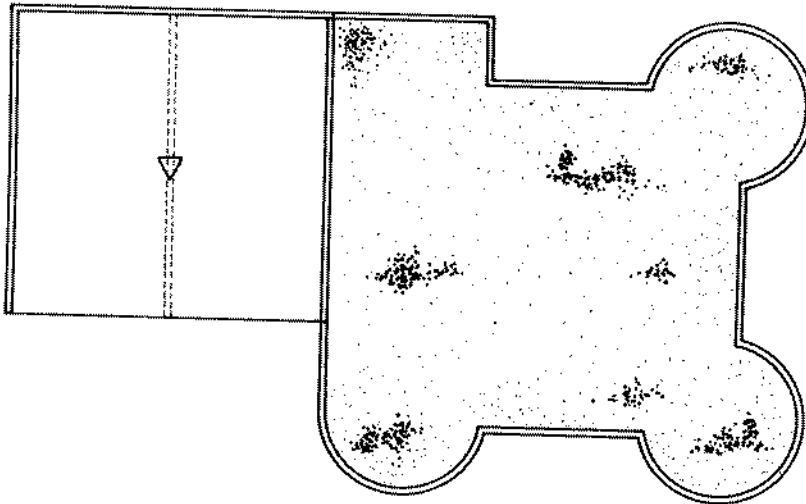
PLANTA DA COBERTURA — ESC. 1:200
